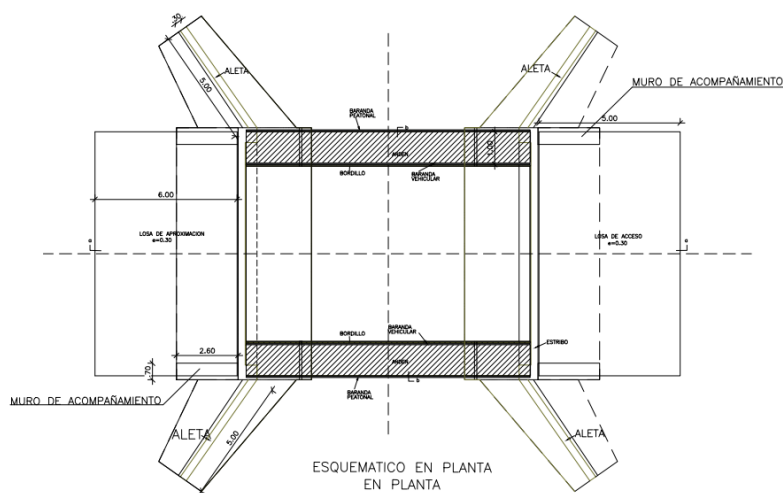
Plano vista transversa Puente vehicular Pital de Megua.
